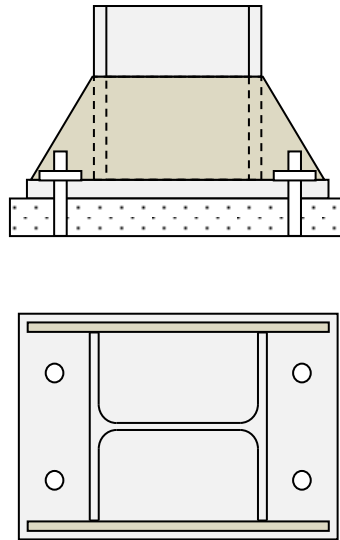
Raidisseurs dans l'extrémité des semelles du pied de poteau
